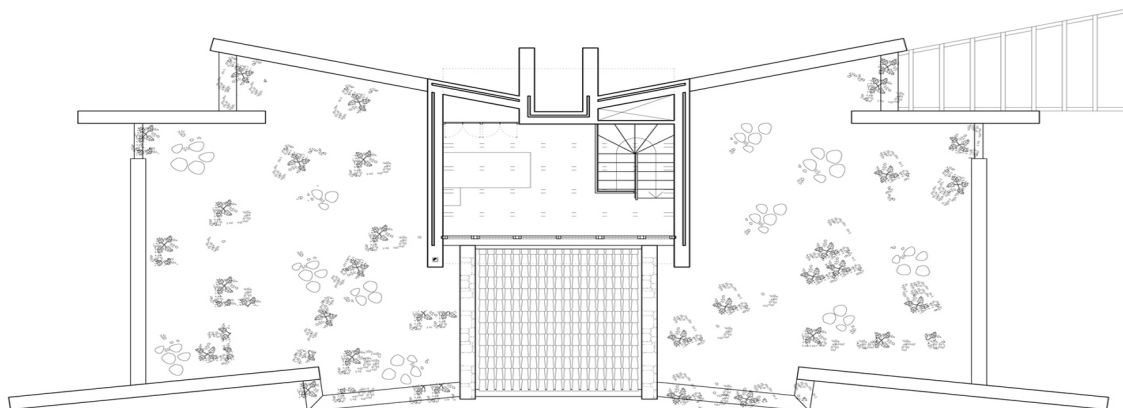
Planta cobertura, Tipologia B, Autor: Luis de Garrido, Fonte Cortesia de Luis de Garrido ARCHITECTS
